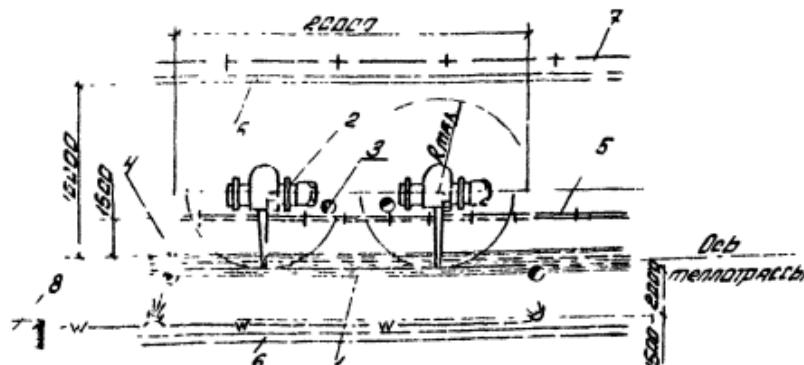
План укладки стальных труб в траншею с теплоизоляцией из минеральными плитками.
